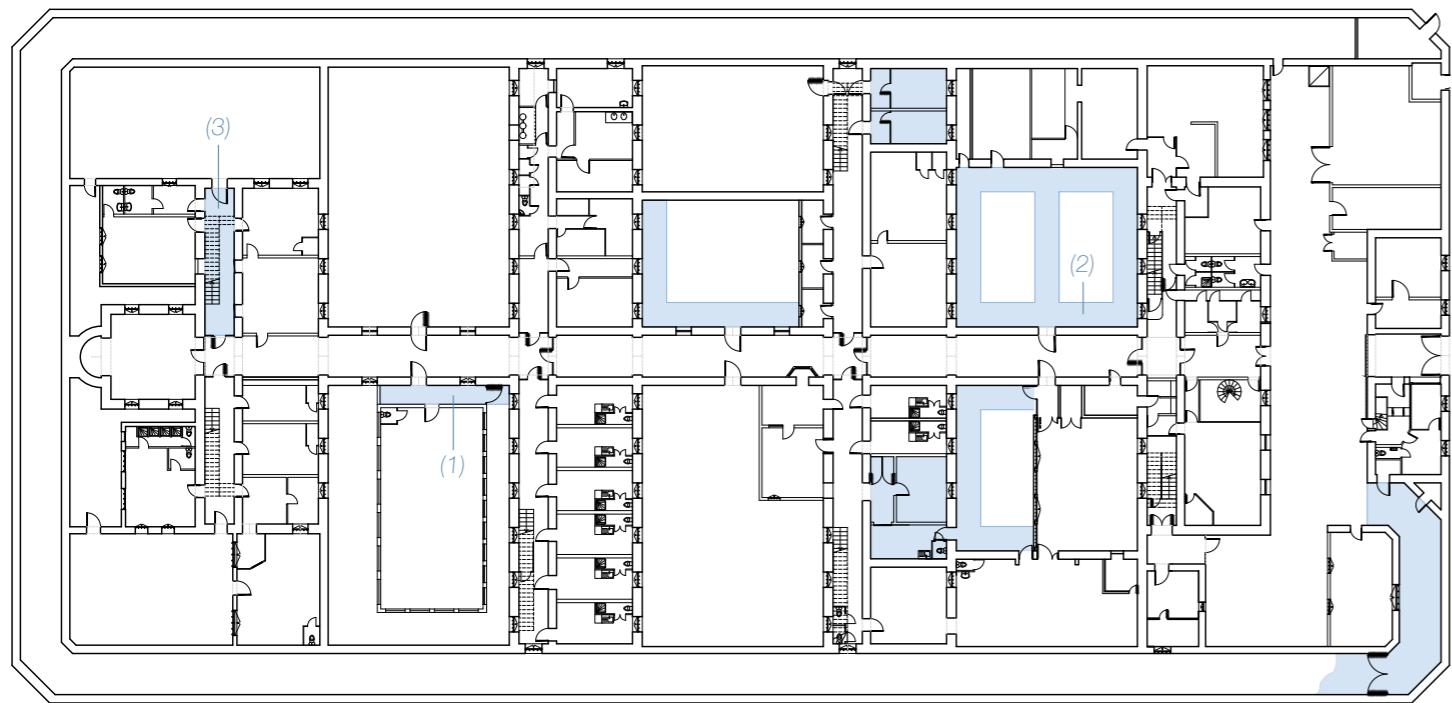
Plan de Rdc : repérage des dallages en pierre de Volvic encore en place. Source : Croisée d'archi.
